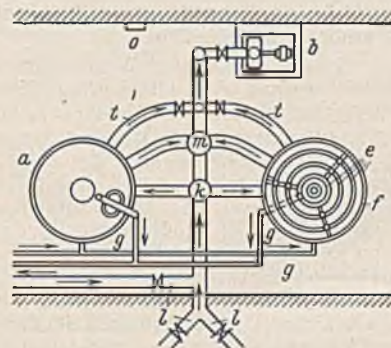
Grundriß der Schlammwärmerungsanlage.
